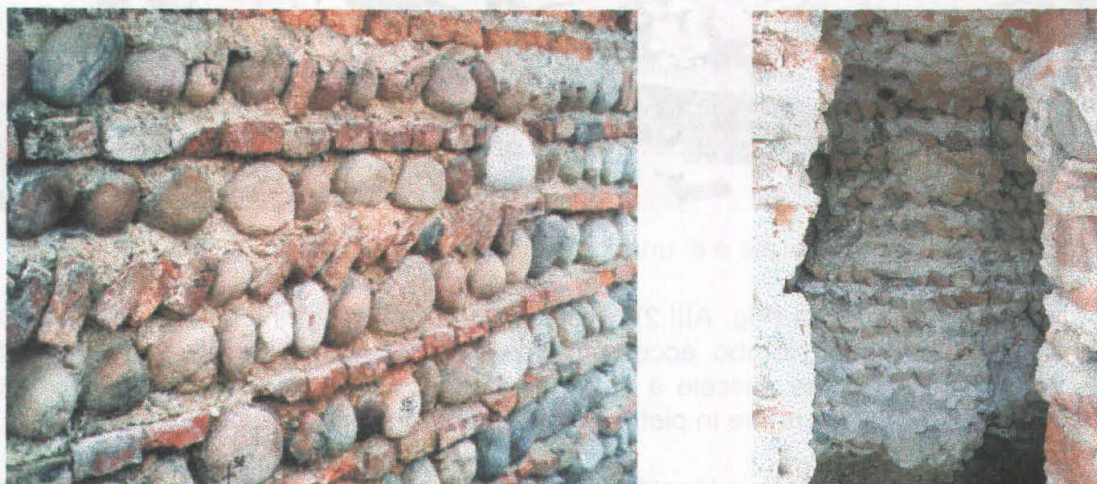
Tessitura del paramento murario e vista della nicchia con accesso dal lato interno delle mura.
